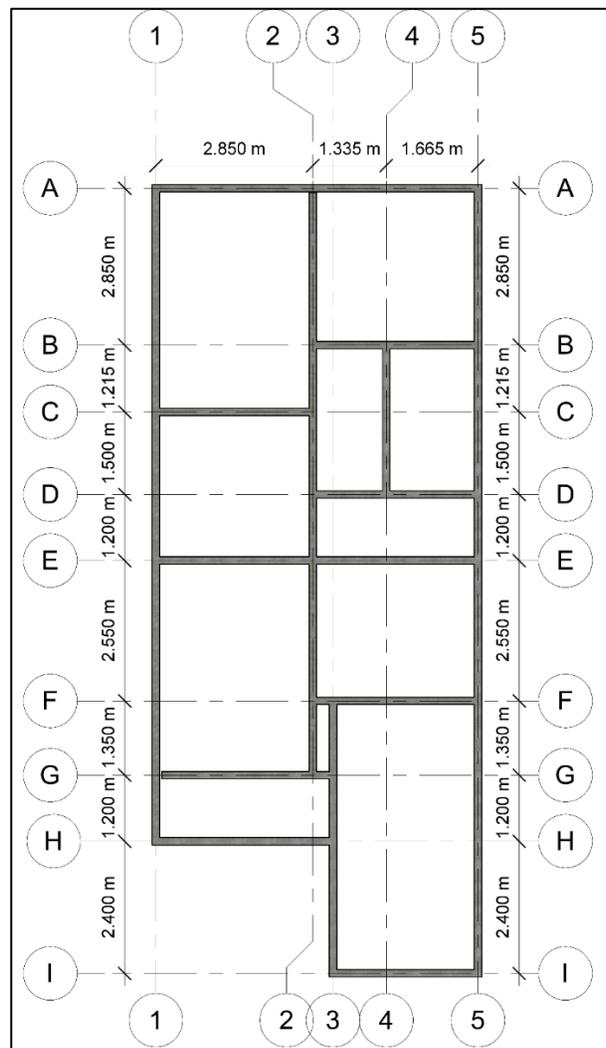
Distribución en planta de las vigas para el segundo nivel.
